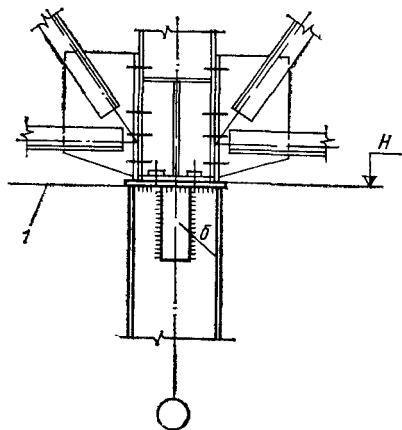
Оголовок колонны среднего ряда кранового здания при отсутствии проходов вдоль подкрановых путей
